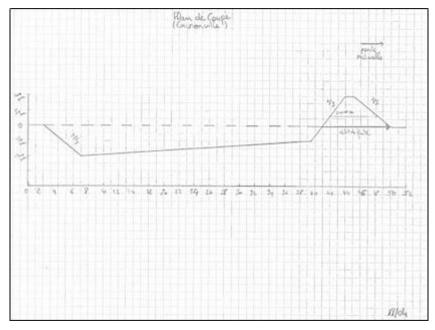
Plan de coupe (source : Cyril LAMARRE)
